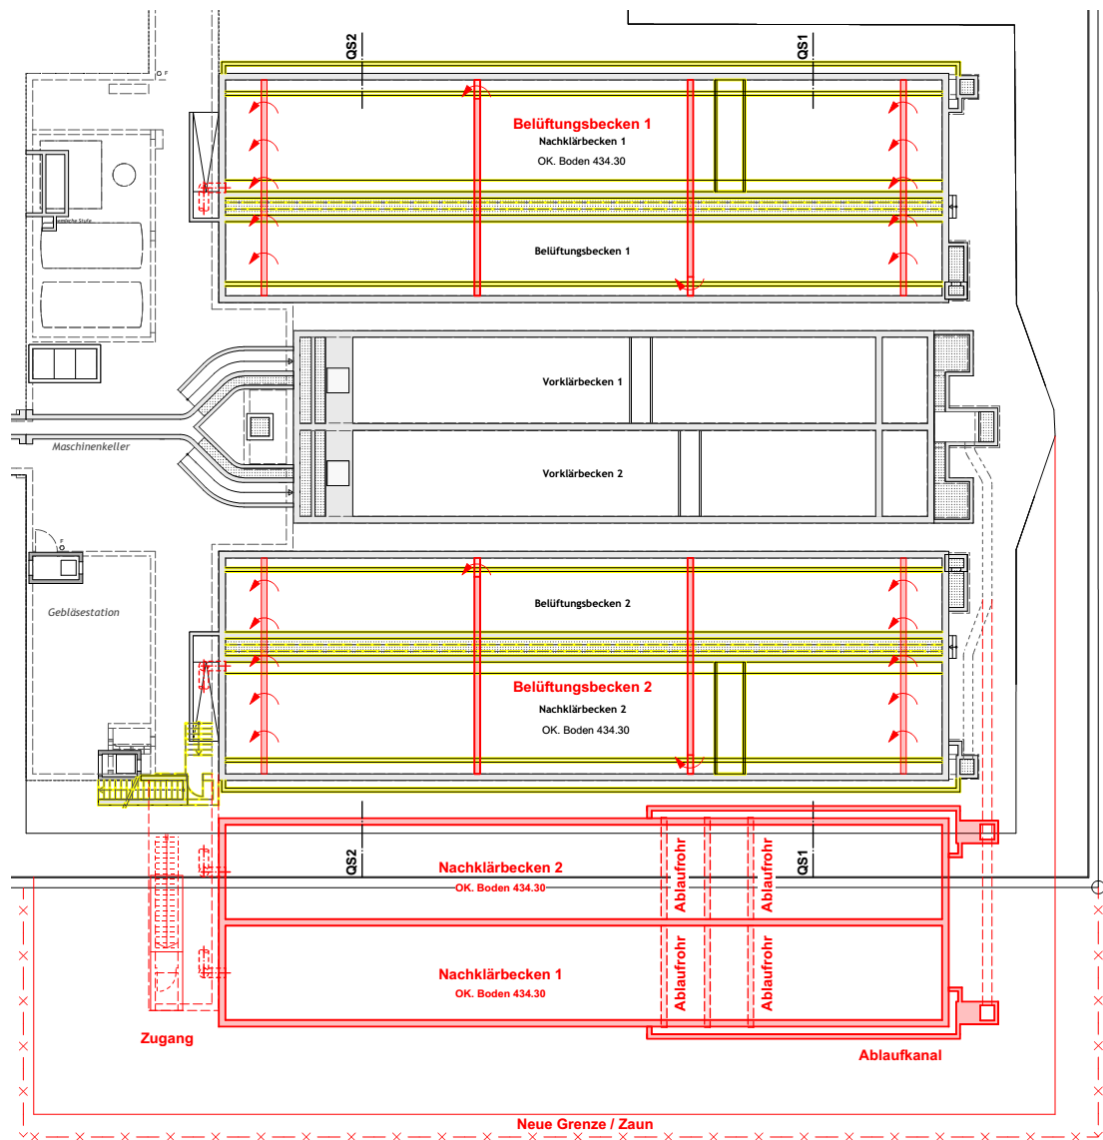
Layout Variante 1.1: Vollausbau konventionelles Belebtschlammverfahren.
